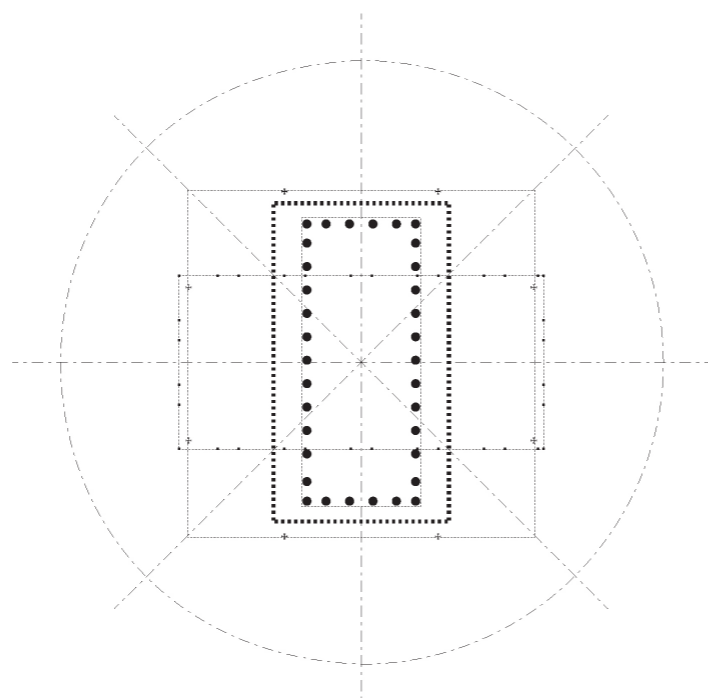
Schema planimetrico sul concetto di simmetria radiale
